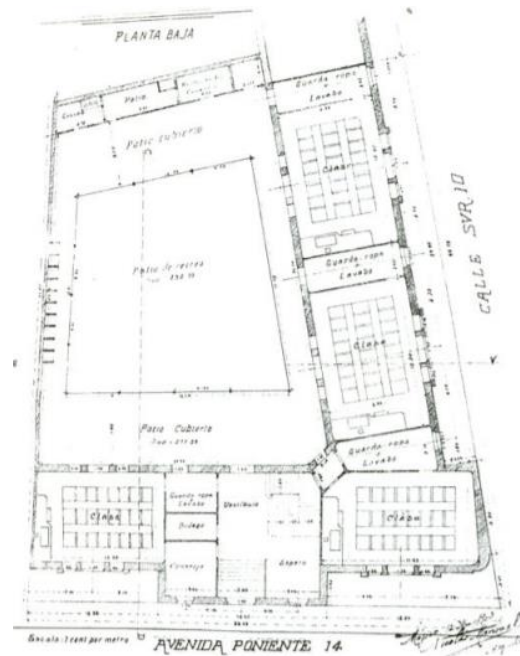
Planta baja de la escuela número 2 de la Ciudad de México (1905).
